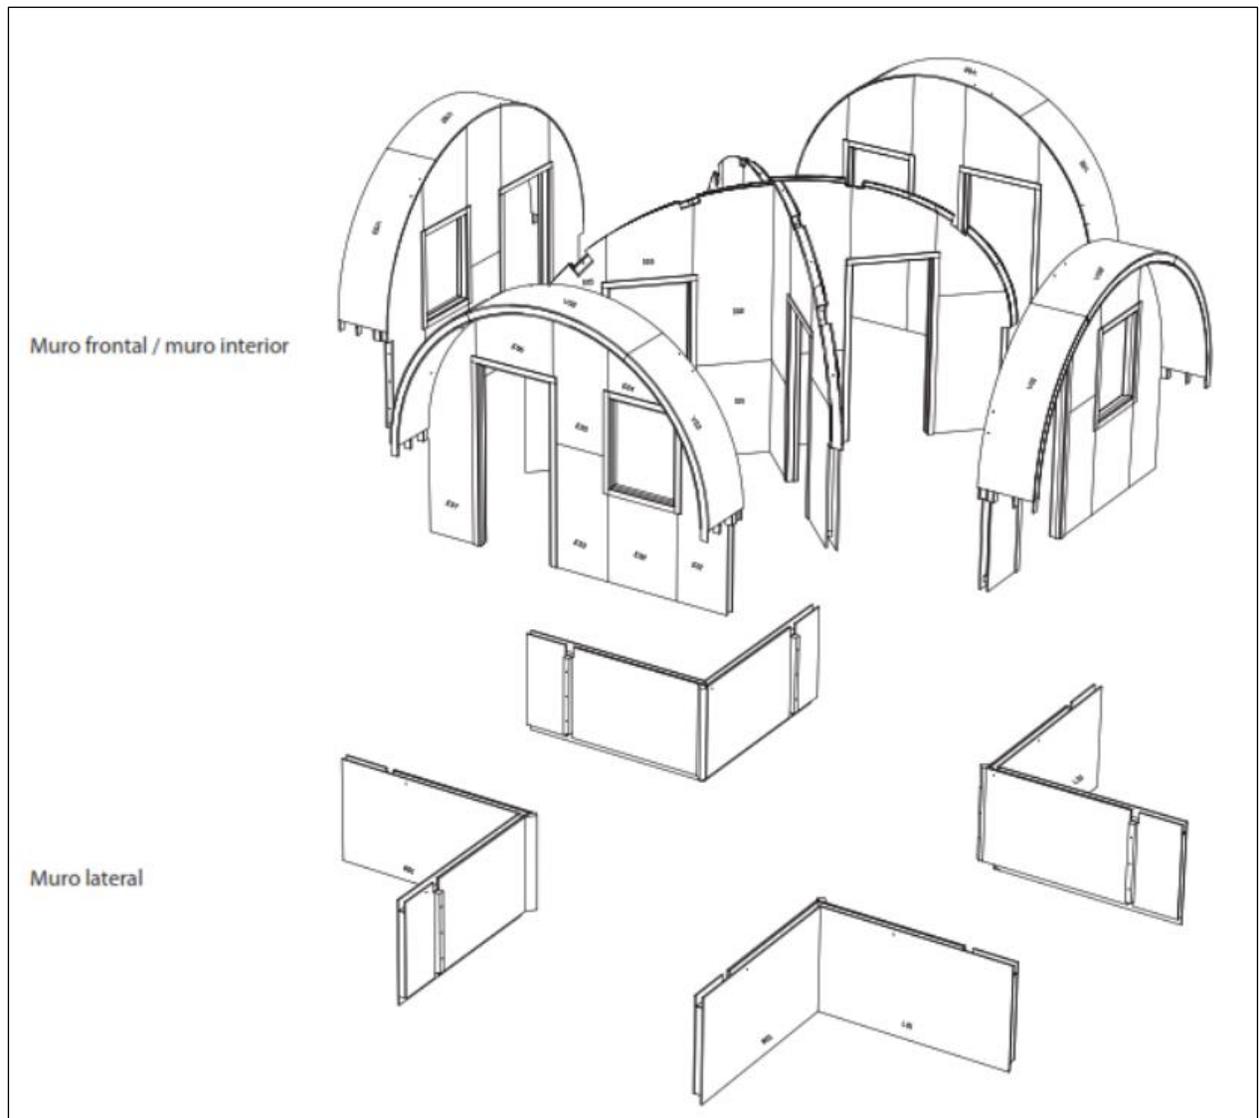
Detalle de ensamble de muros internos y externos Red+Housing
